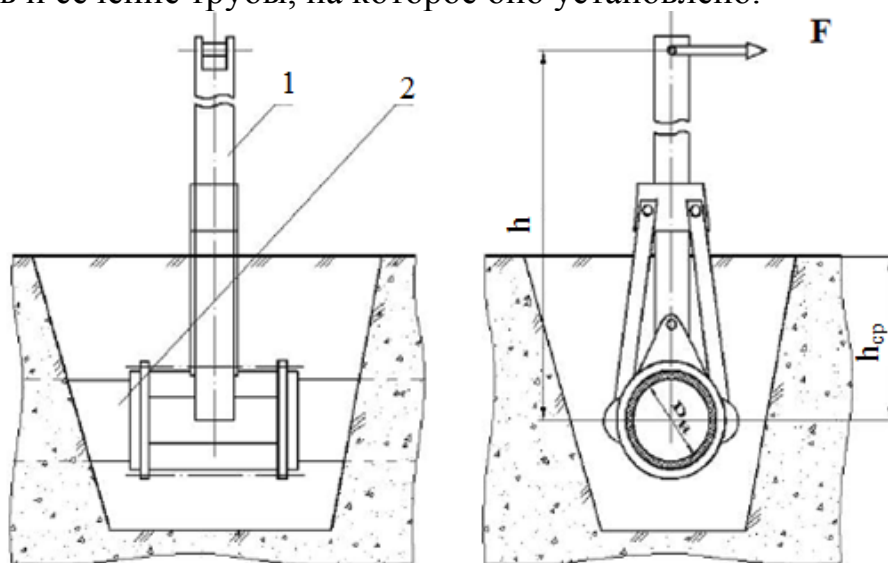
Схема передачи крутящего момента на подземный трубопровод:
